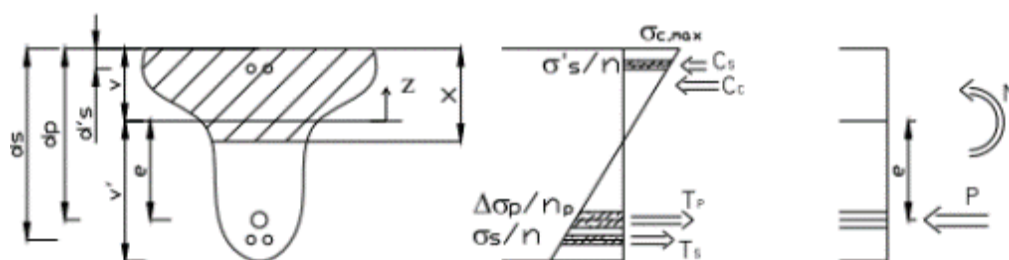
Equilibrio Interno en una sección pretensada fisurada.
